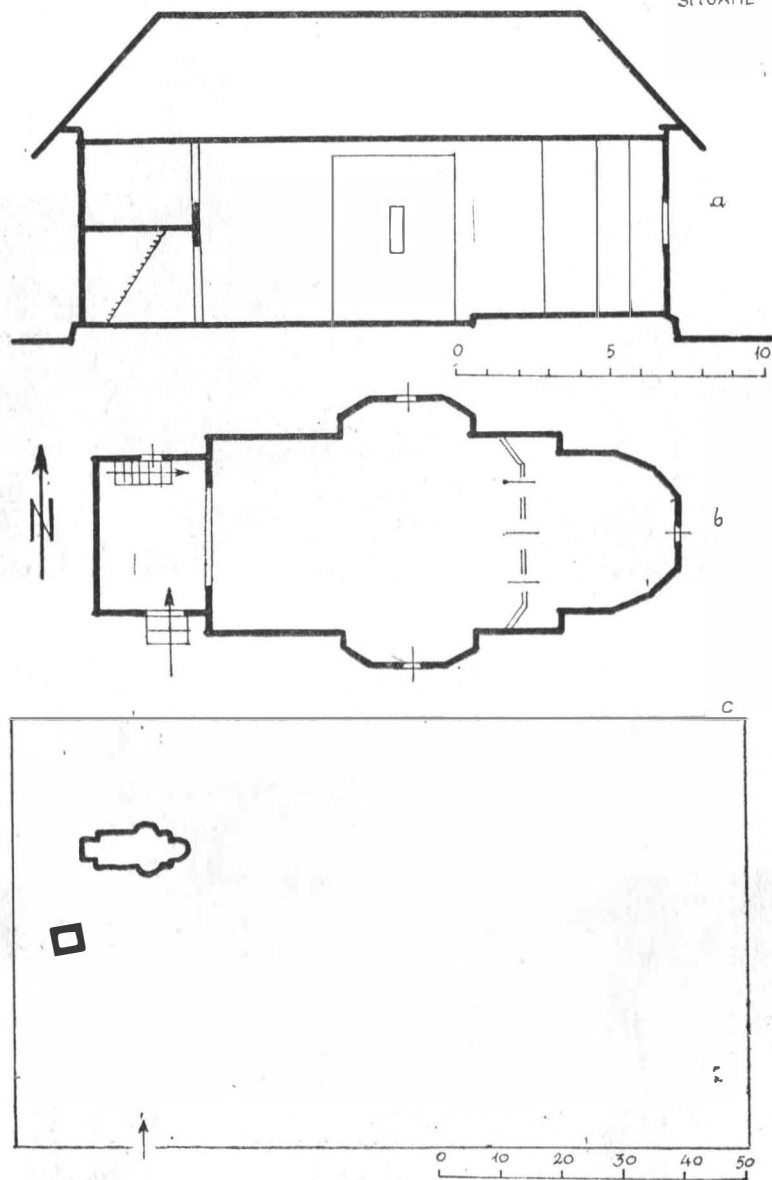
Biserica de lemn Lărgășeni-Vrancea. a. elevația. b. planul. c. plan de situație.
